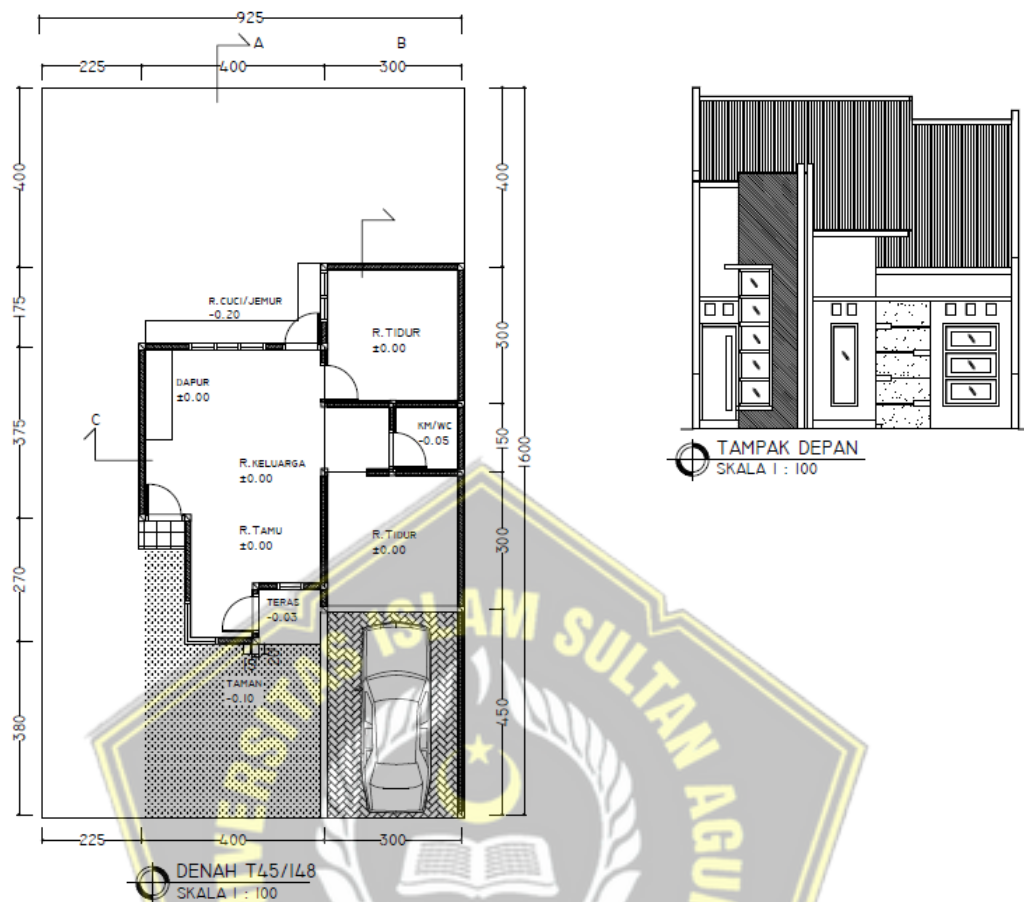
merupakan denah letak ruangan dan tampak depan dari bangunan rumah tipe 45 dengan luas bangunan 45 m^2 dan luas tanah 84 m^2 .
